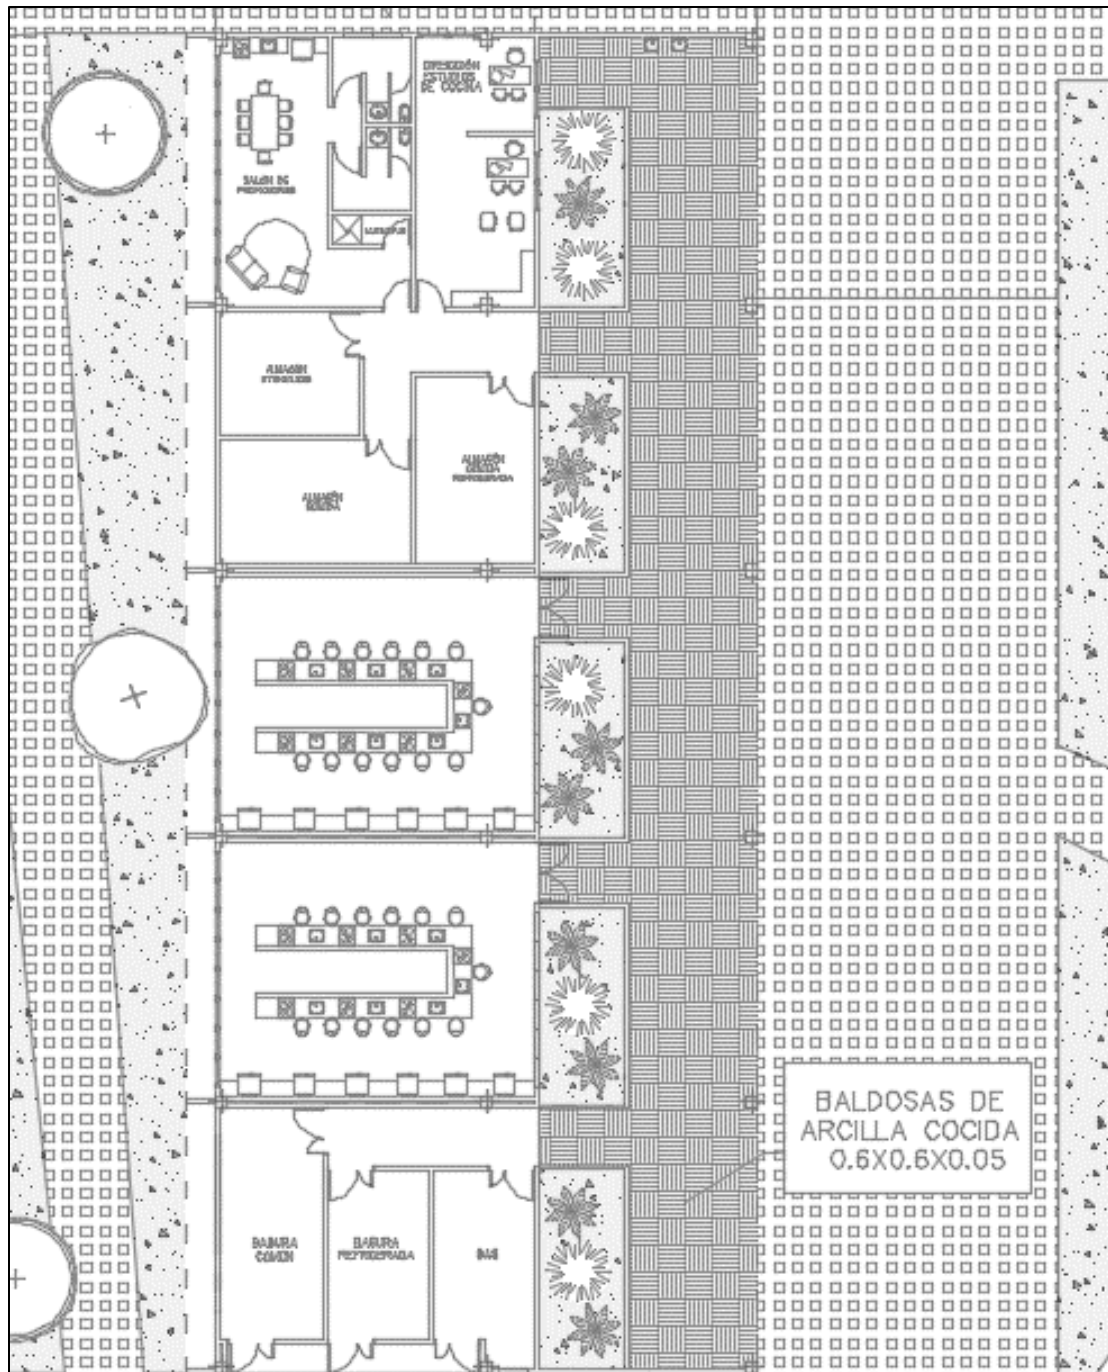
Planta Baja Módulo Culinario. Fuente: Propia autoría. (2018).
